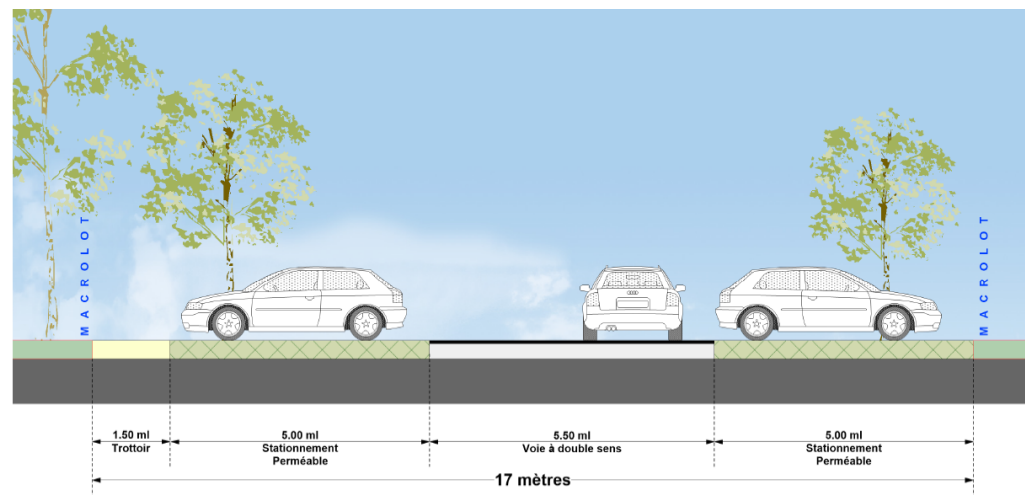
Coupe de voie secondaire (à double sens) (coupe de principe), après modification
